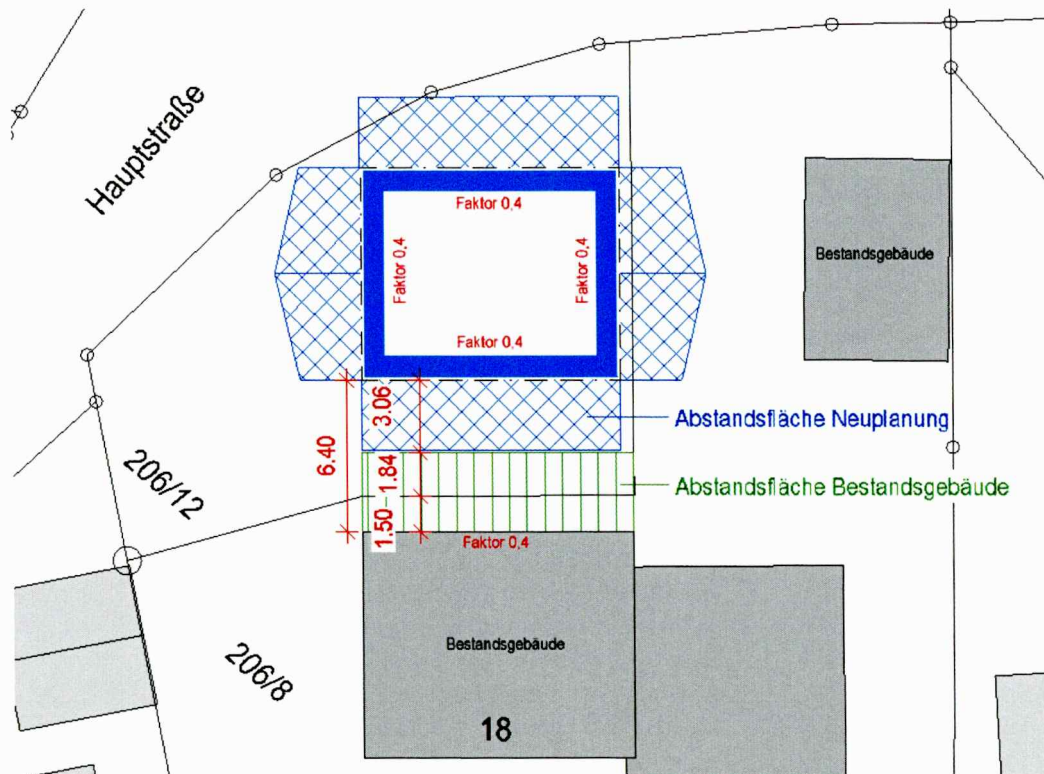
Planausschnitt Abstandsflächenübernahme Bestand/Neubau, unmaßstäblich
